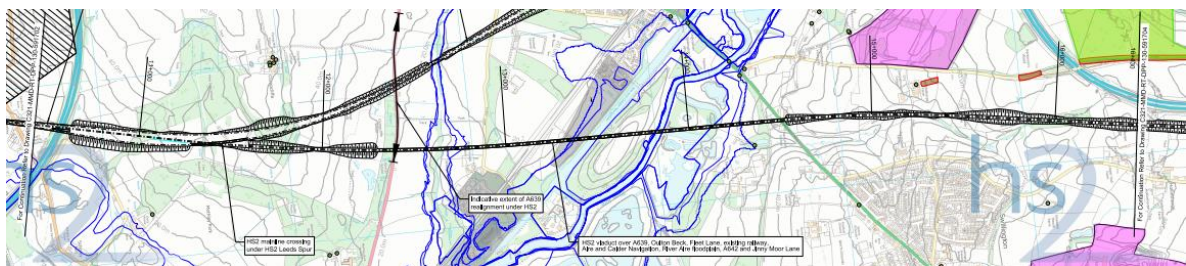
Planta do traçado viaduto sobre a A639, Oulton Beck, Fleet Lane, bacia de cheia do Rio Aire (Unido, HS2 Phase 2b: Charlston Common to Church Fenton route sheet 2).
